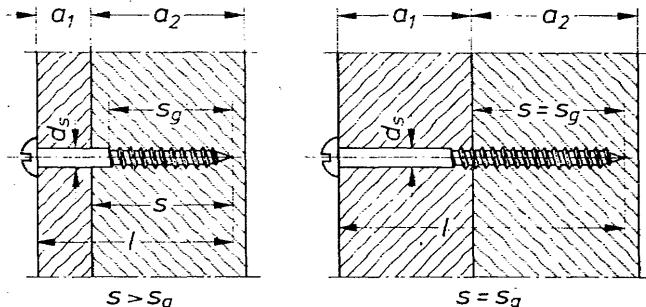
Holzdicken und Einschraubtiefen bei Holzschrauben
